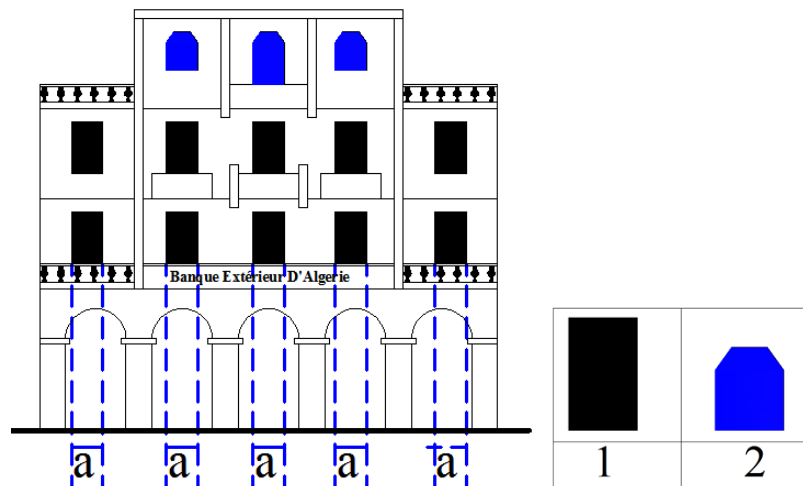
Hiérarchisation des balcons de la façade de l'immeuble BEA
